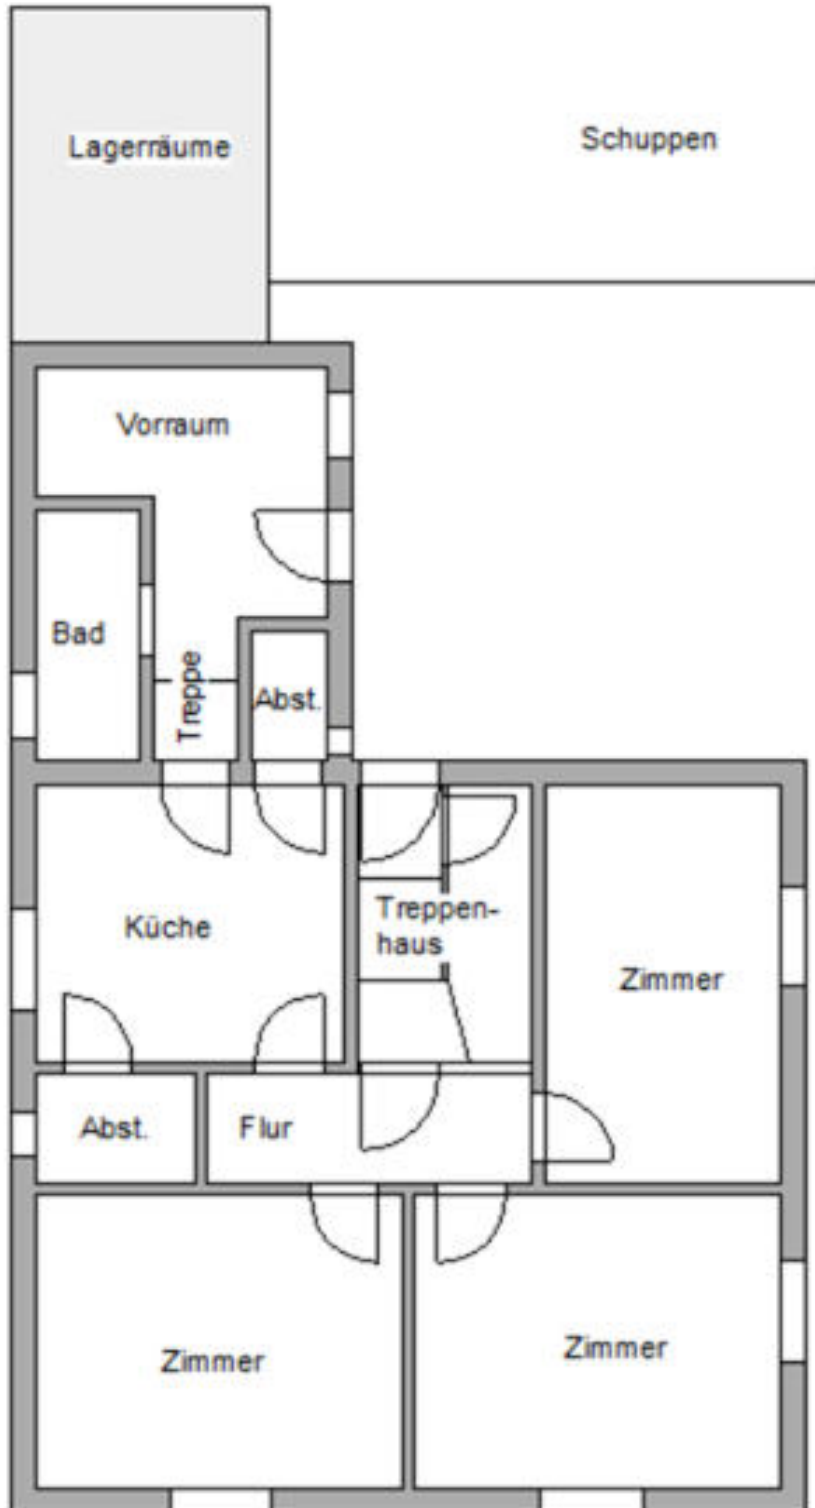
Erdgeschoss, grob schematische Grundrisskizze des SV (ohne Maßstab)
